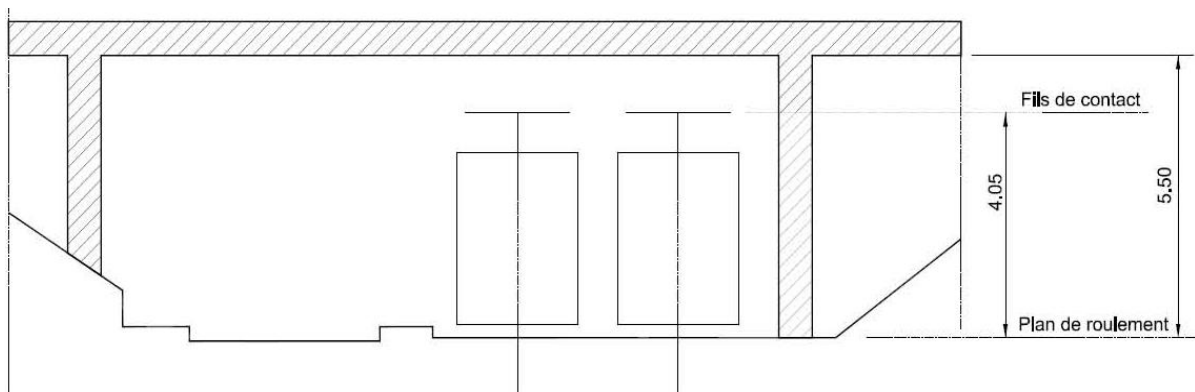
Gabarit minimal vertical entre le plan de roulement du Tramway et un pont. [2]
